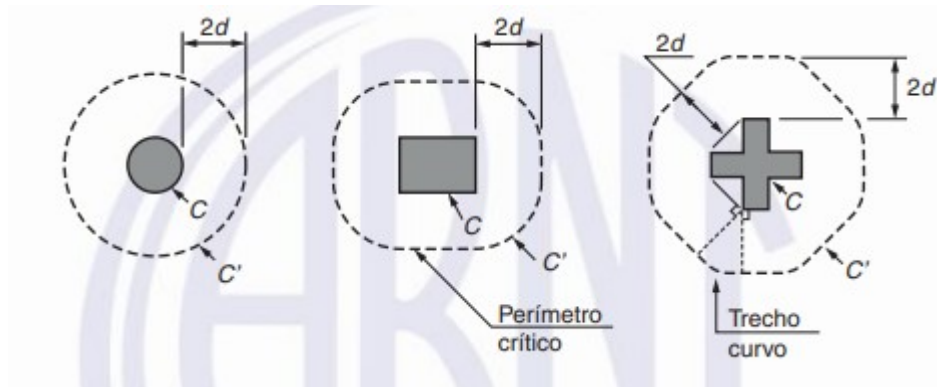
Exemplo de Perímetro Crítico C' dos Pilares
